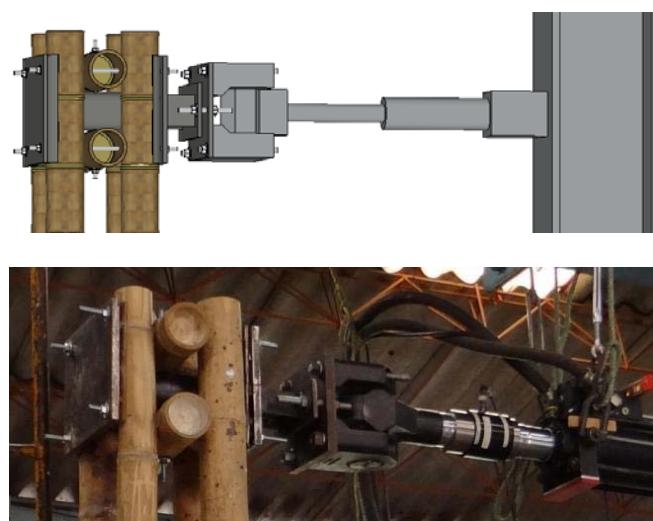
Soportes metálicos para restringir el giro de la vigas de centrado.
